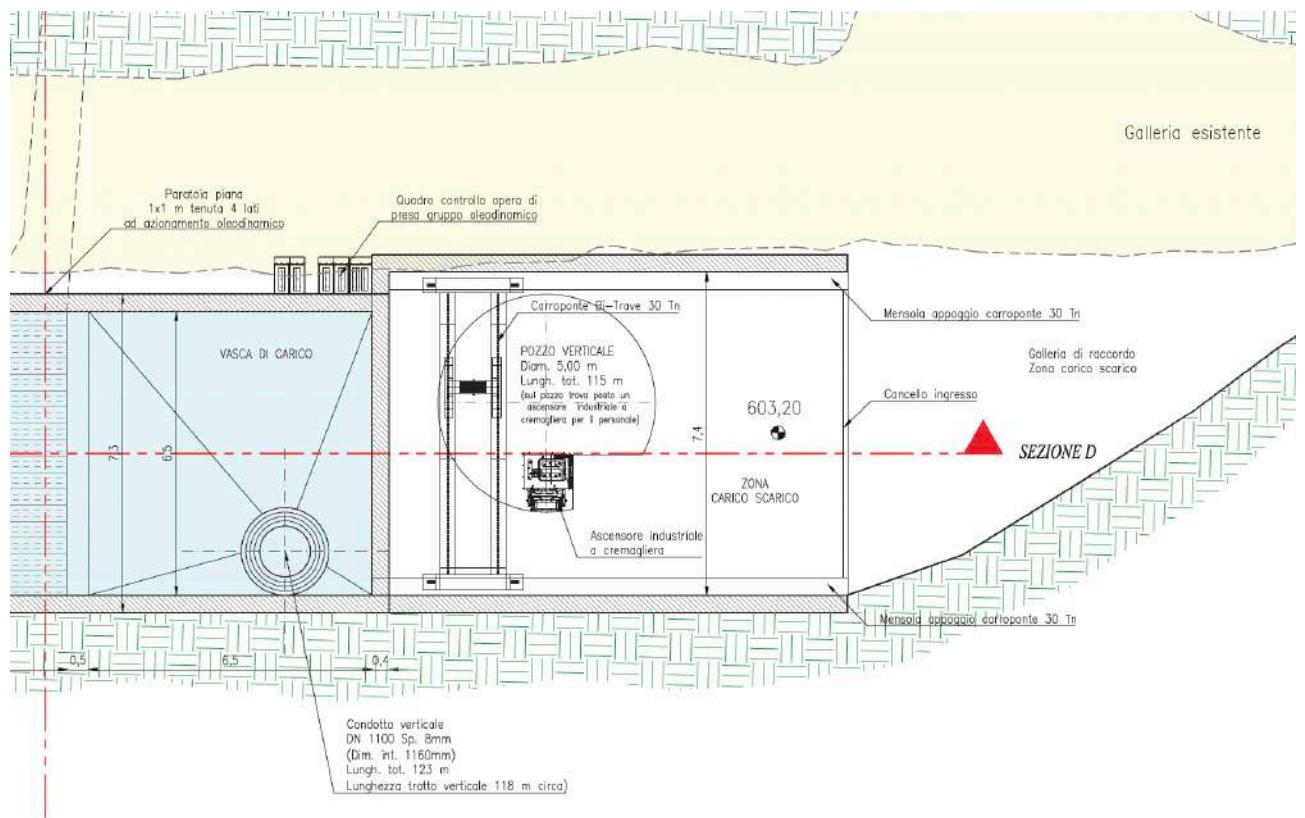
Planimetria di progetto dell'opera di presa che evidenzia condotta verticale e pozzo
